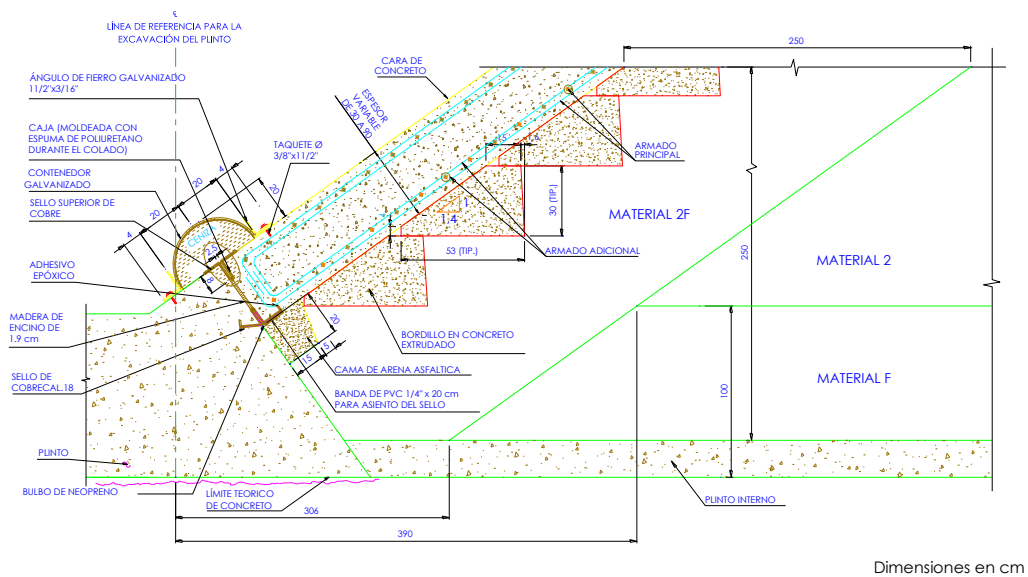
Detalle de la zona de soporte de la cara de concreto
